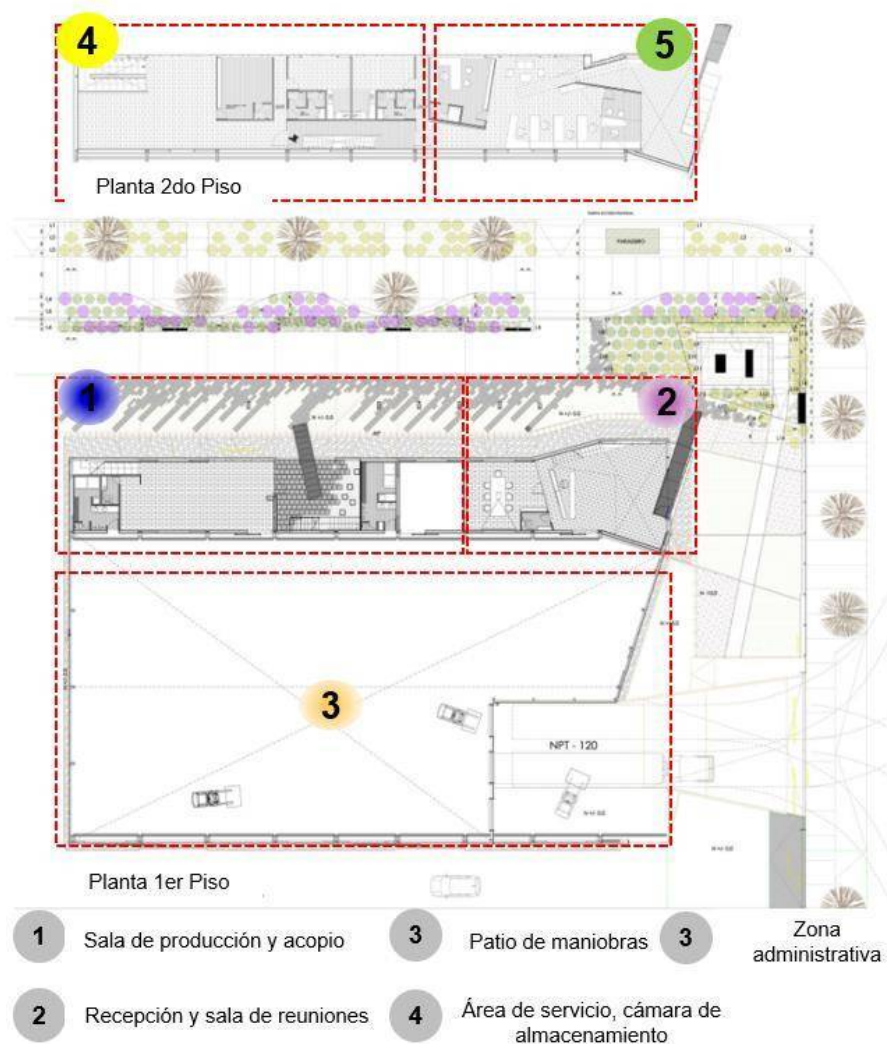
Planta de distribución de Bodega y oficina Huanacu
